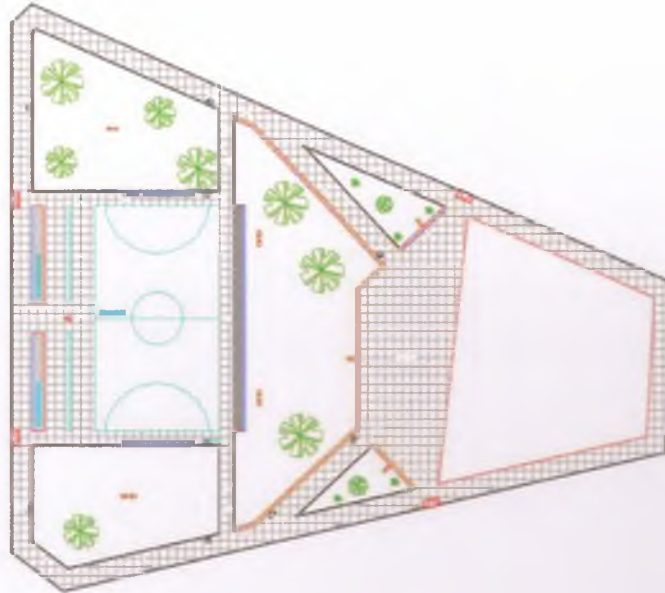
Planta baixa da Praça do Vitória Nossa.
